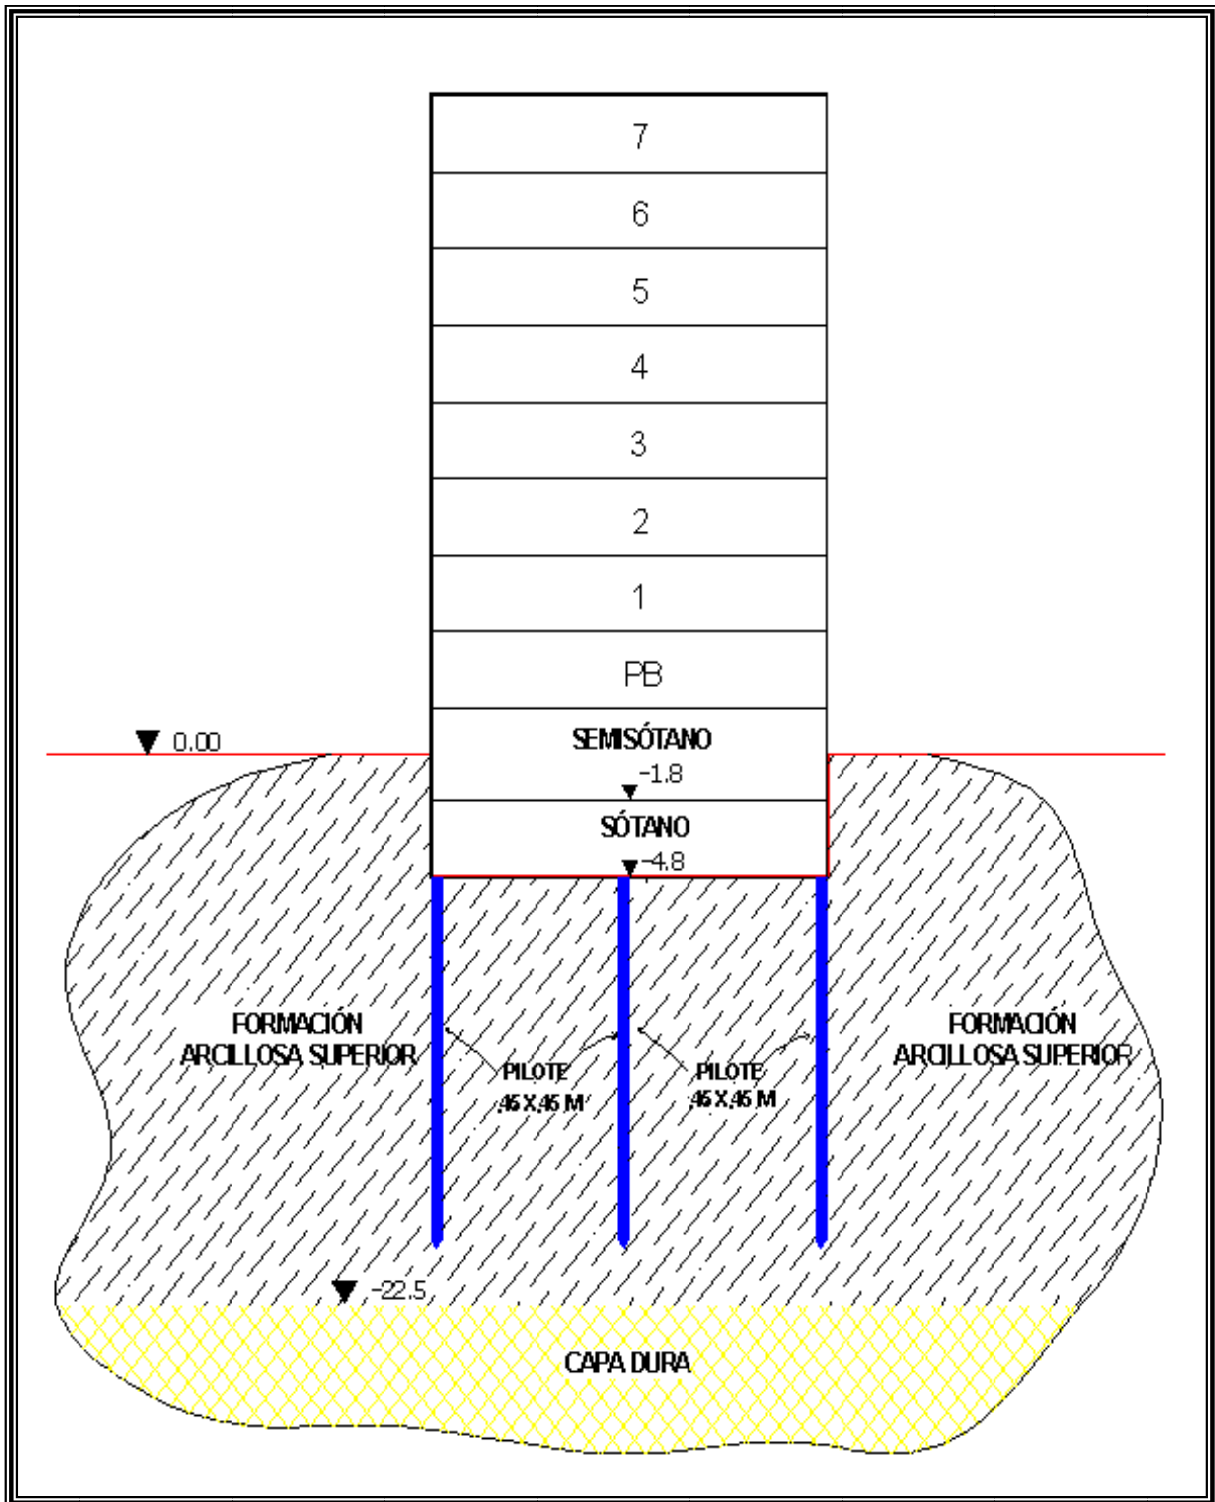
CAJÓN DE CIMENTACIÓN PARCIALMENTE COMPENSADO CON PILOTES DE FRICCIÓN
